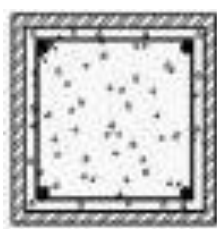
Pilar retangular totalmente preenchido. Fonte: ABNT/NBR8800:2008
